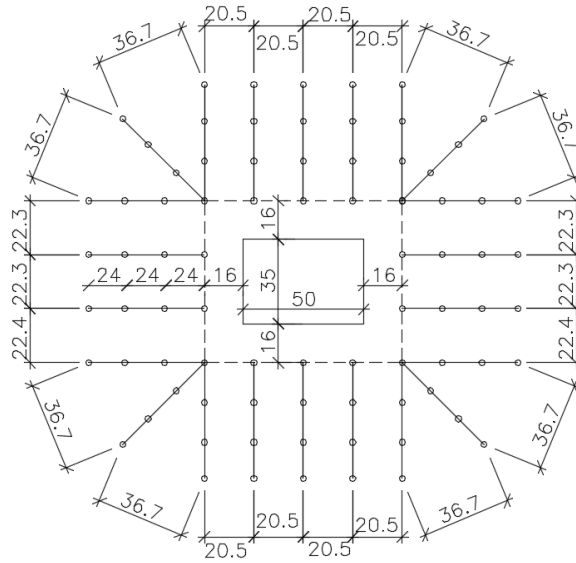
Armadura de cisalhamento ao redor do pilar P11 – Medidas em cm
